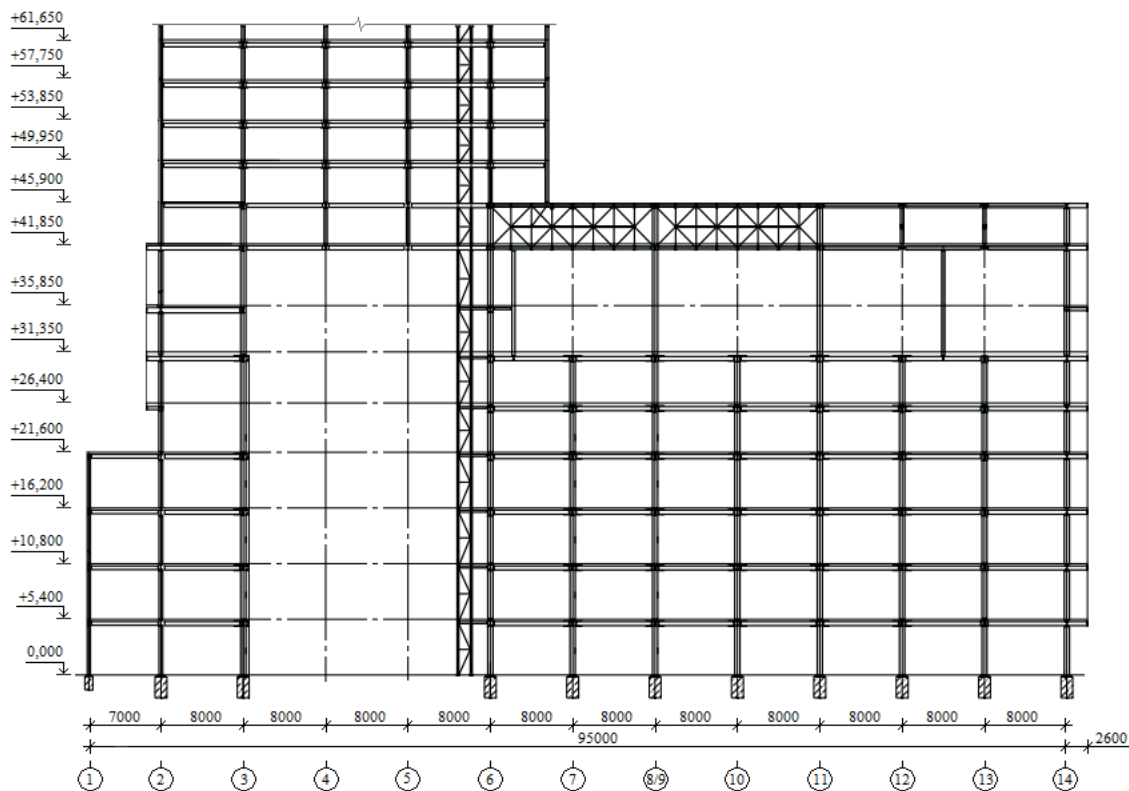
Поперечний переріз будівлі ТРЦ по осі Ж
